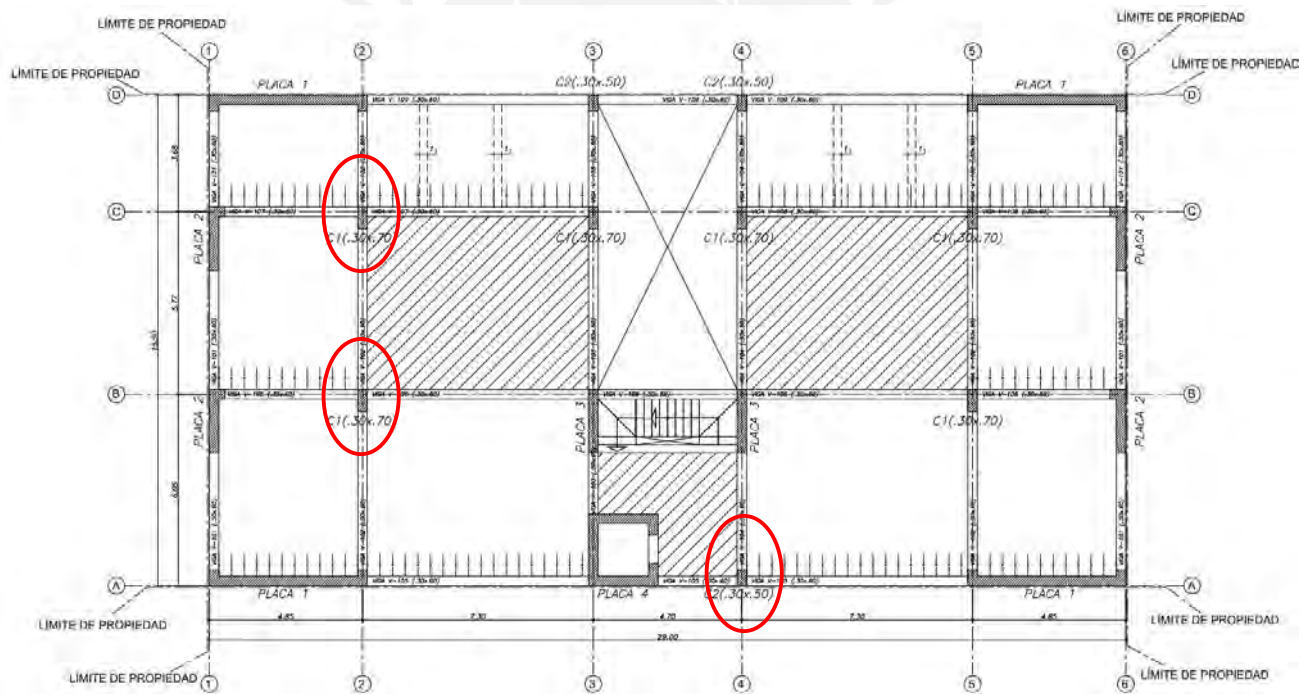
Ubicación en planta de las columnas a diseñar
